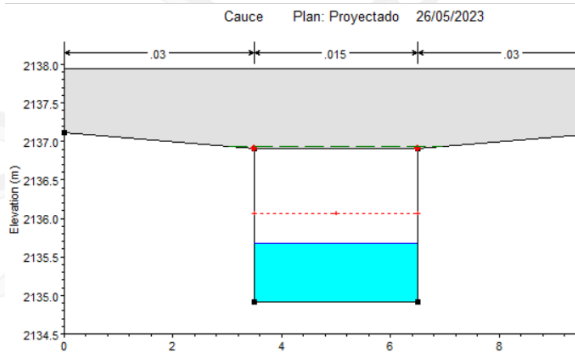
Sección 60, Box Culvert 2- (Aguas abajo)- Abscisa 0+173.72
